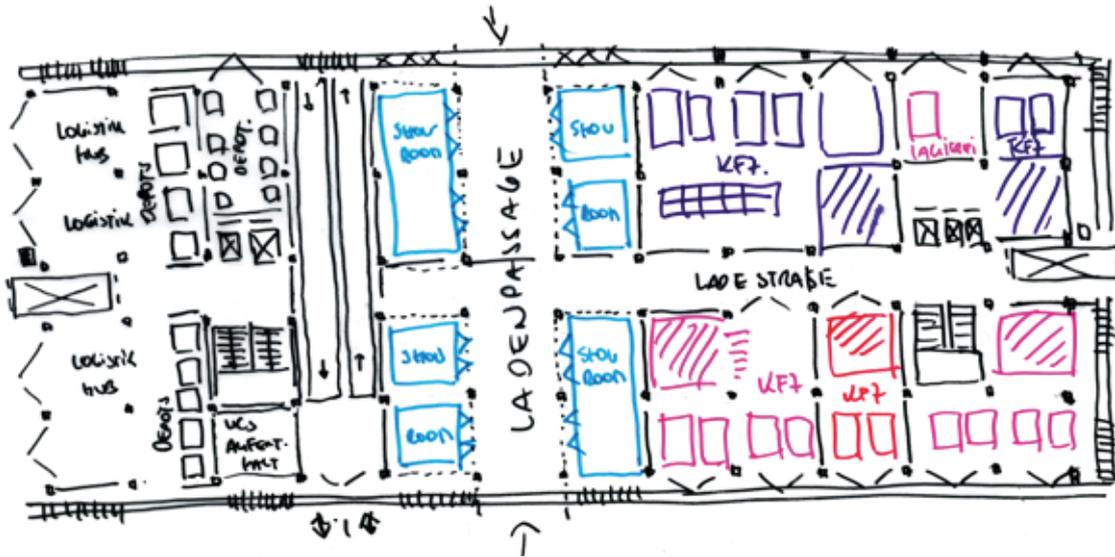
Grundriss EG Hauptgebäude Gewerbegebiet
